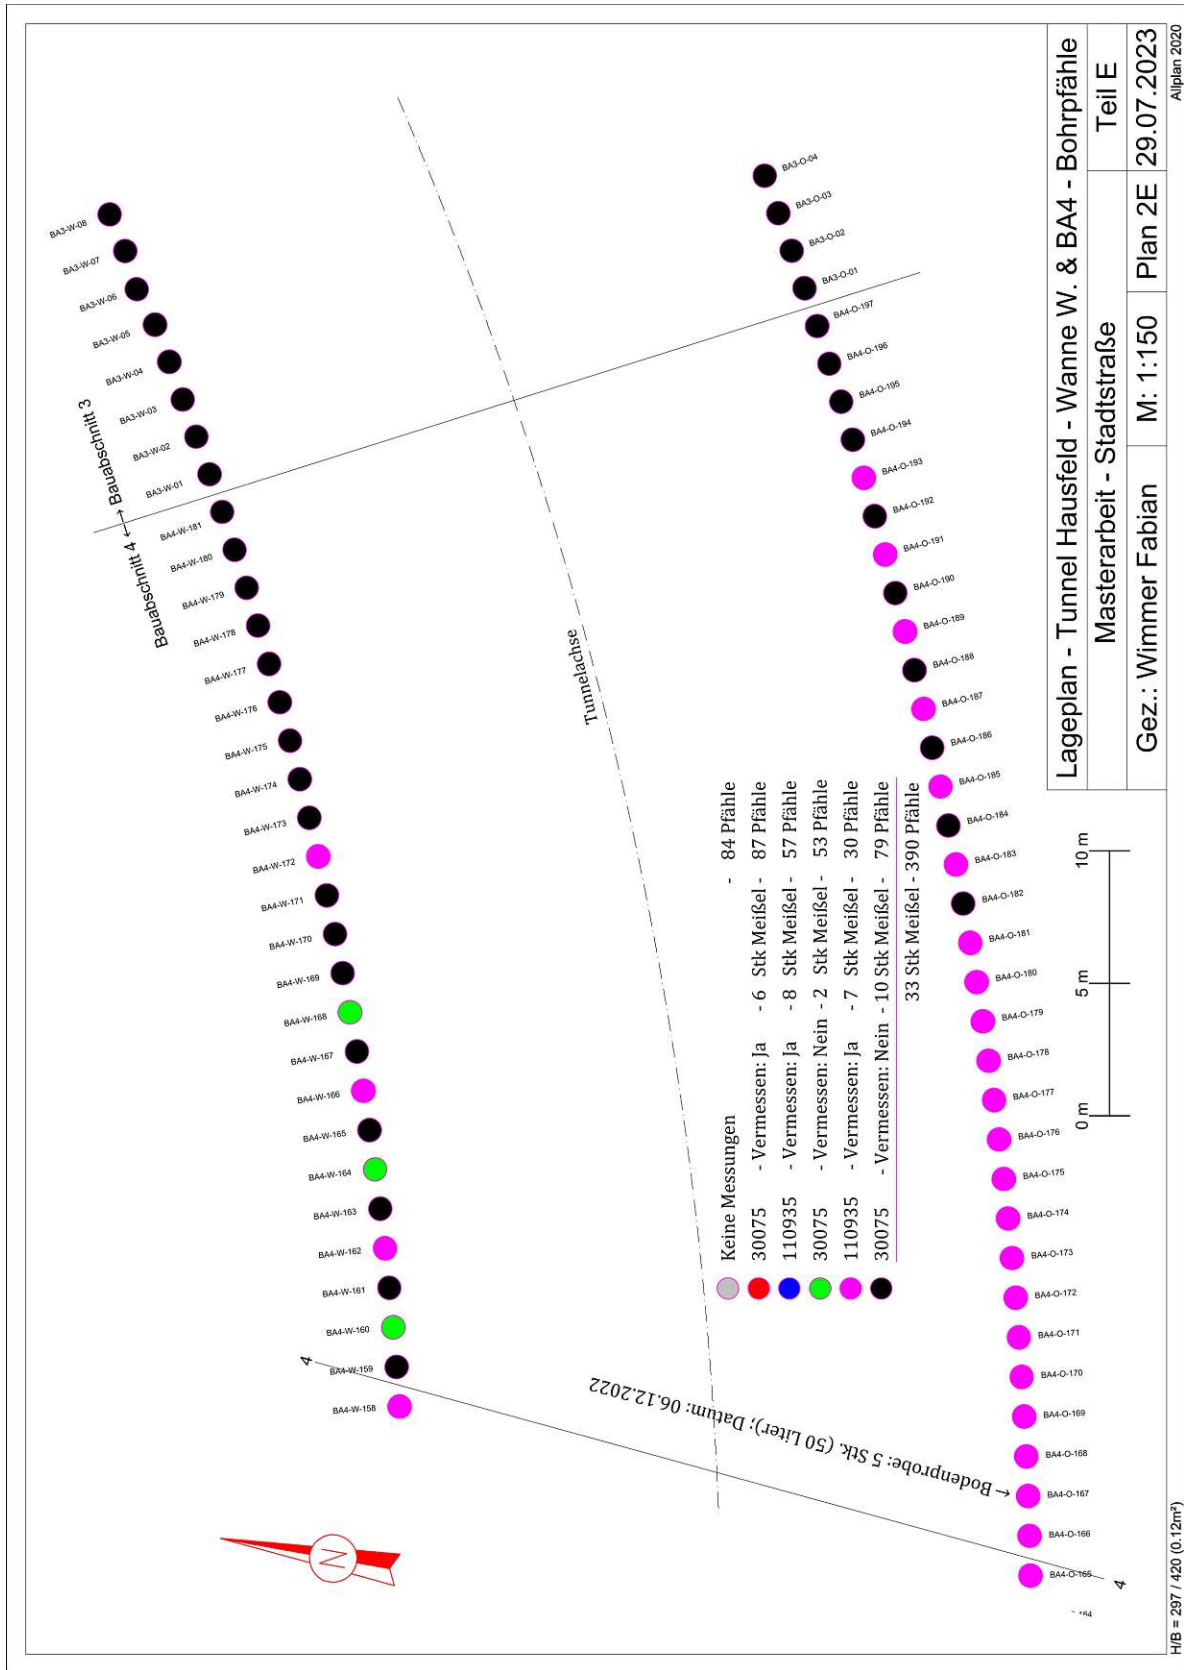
Lageplan - Tunnel Hausfeld, Wanne West und BA4 - Detailansicht Plan 2E; Plangrundlage [15]
